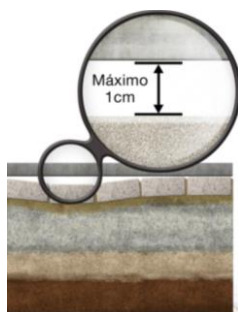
Desnível máximo permitido para o pavimento intertravado
